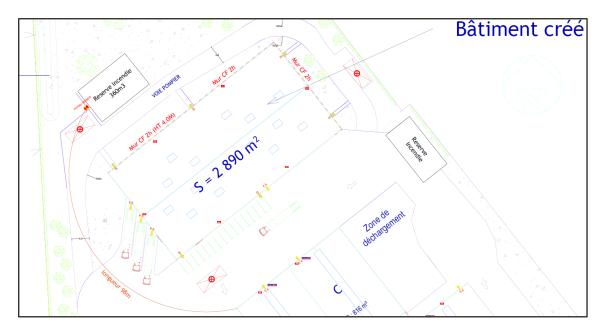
Localisation des murs coupe-feu futur bâtiment (source: sicabconstruction)
